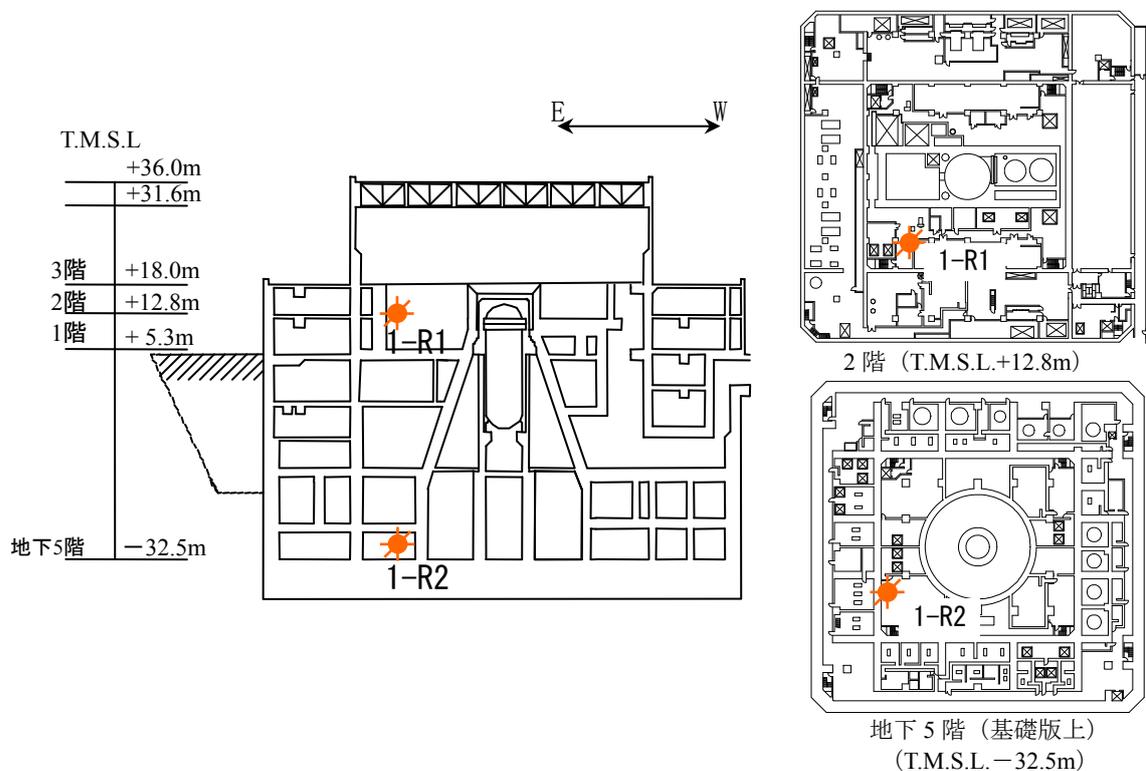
1号機原子炉建屋地震計配置図 (赤星部)
